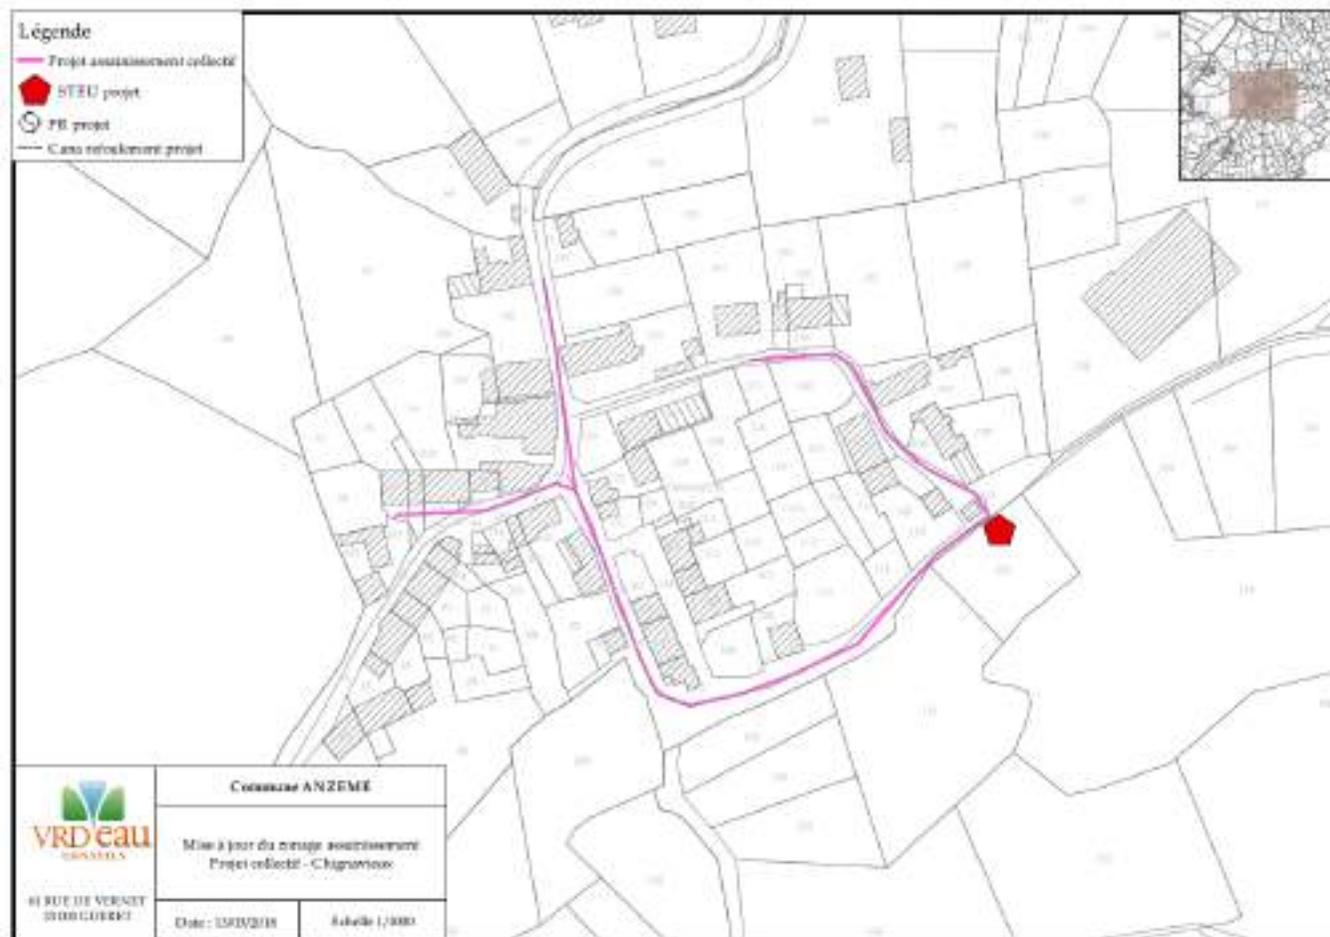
projet d'assainissement collectif sur le village de Chignavieux
